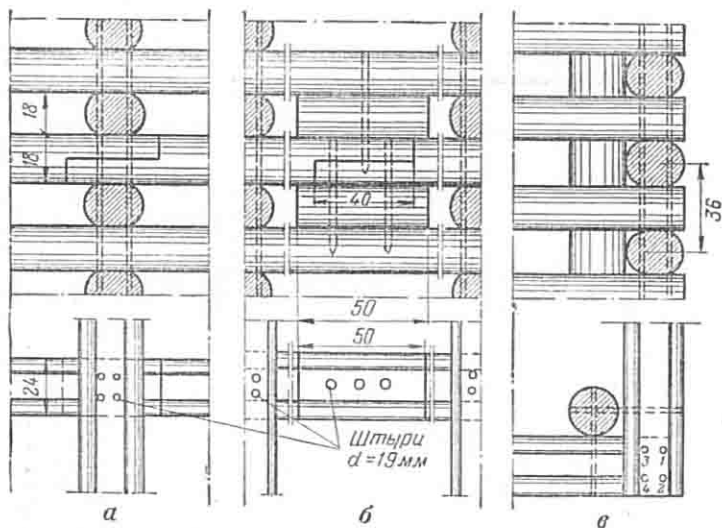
Пример конструкции ряжевой опоры без врубок:
